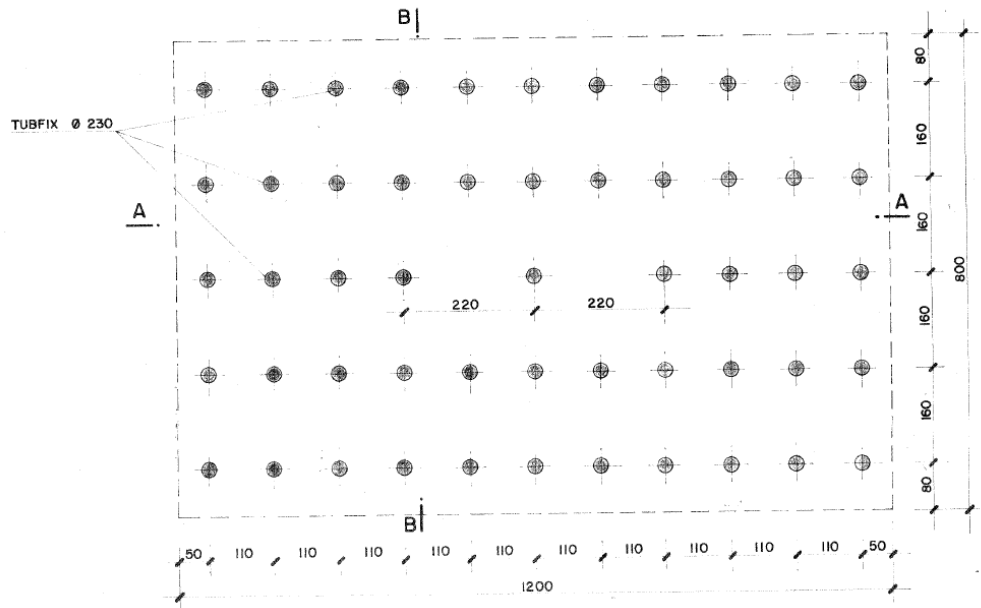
Pianta Spalla A e spalla B su micropali
